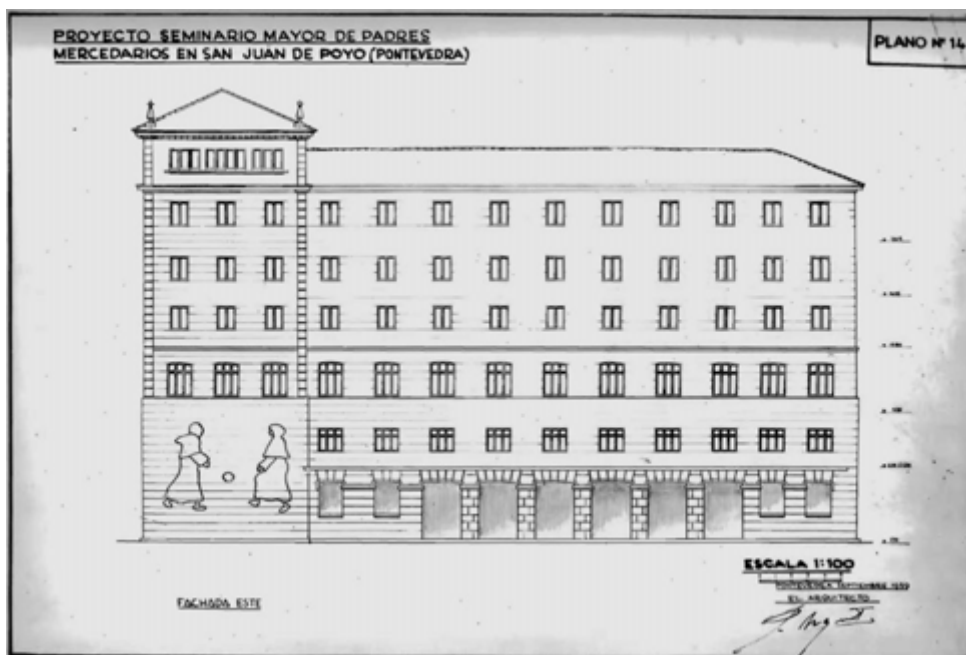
Fachada Este. Fuente: Archivo Provincial.
